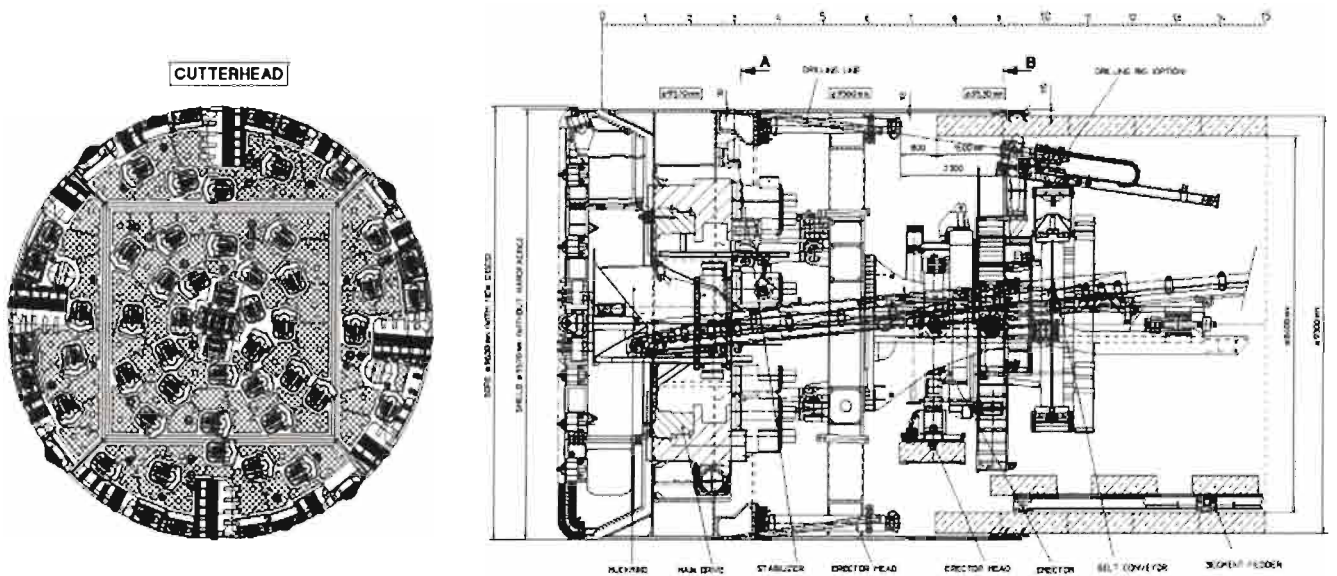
TBM scudata da roccia - Testa fresante e sezione longitudinale scudo
